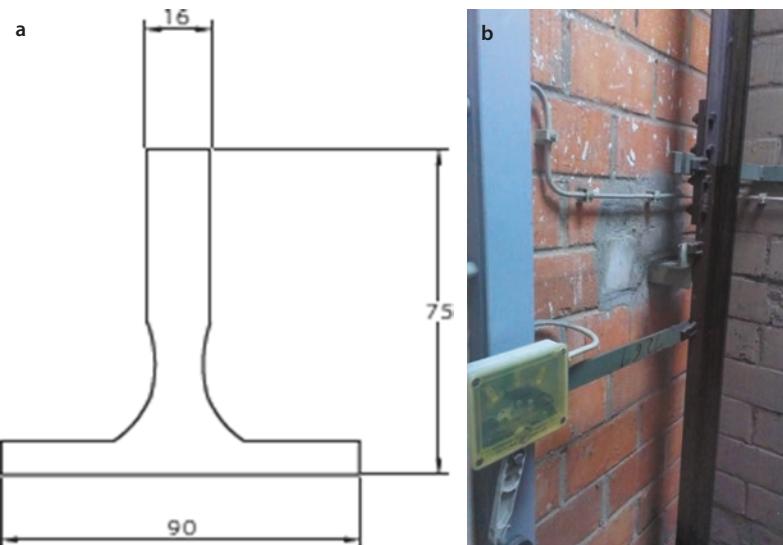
(a) Ansicht einer Führungsschiene, (b) Eingemauerte Halterung für Führungsschienen
